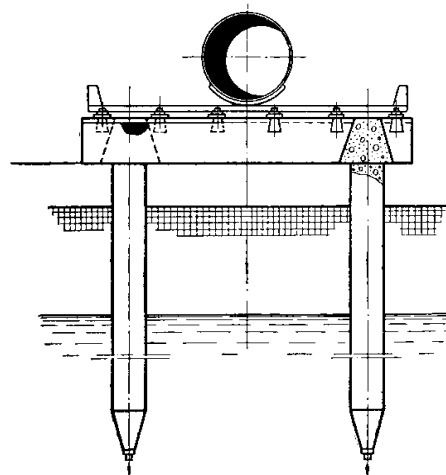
Схема розташування трубопроводу на пальових опорах
